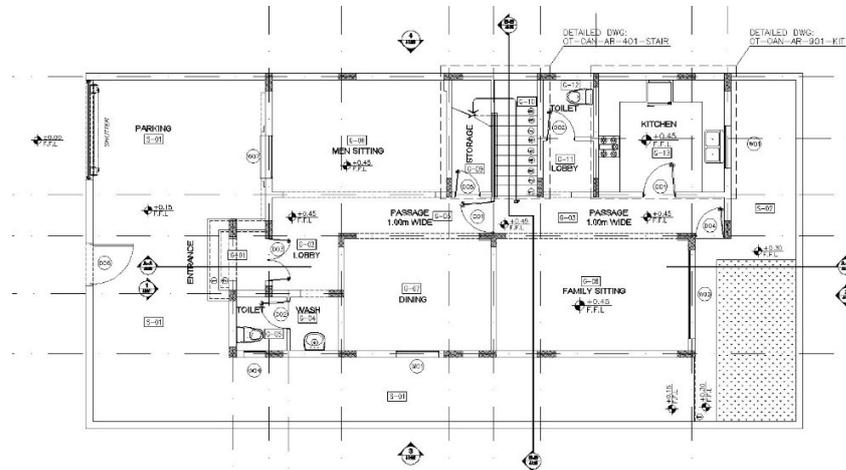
Planta baja arquitectónica. Proyecto Al Otaibi
